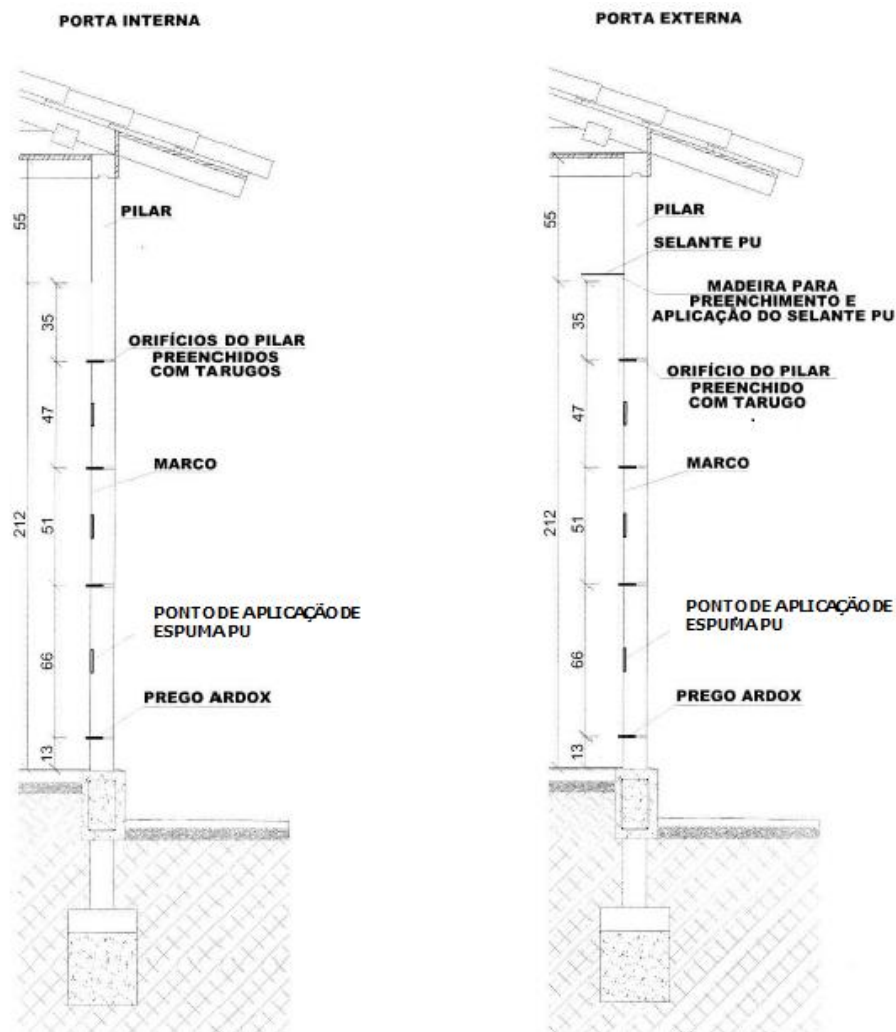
Desenho esquemático da fixação dos batentes de portas nos pilares pré-fabricados.
